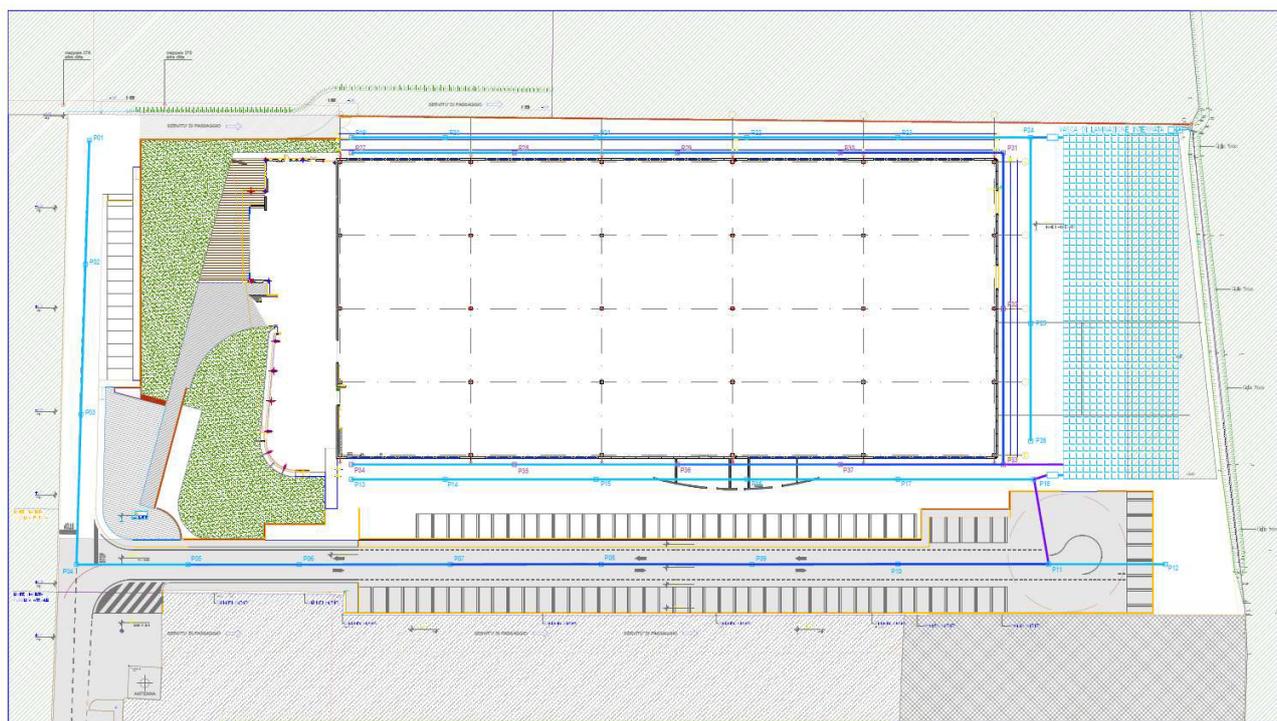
Stralcio della planimetria di progetto dell'intervento
